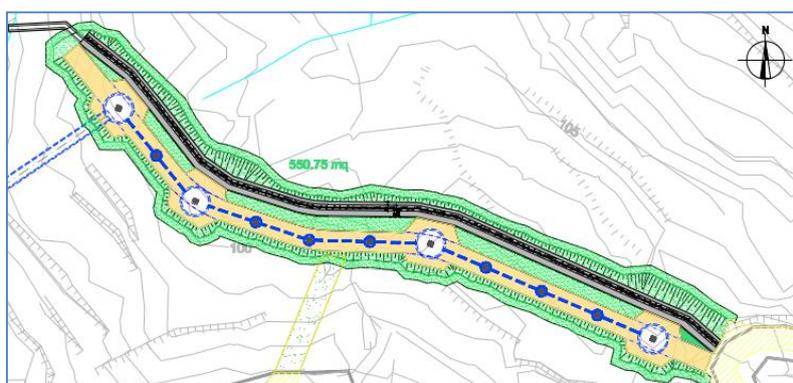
Inerbimento area lavorazione “pozzi drenanti”-pianta
